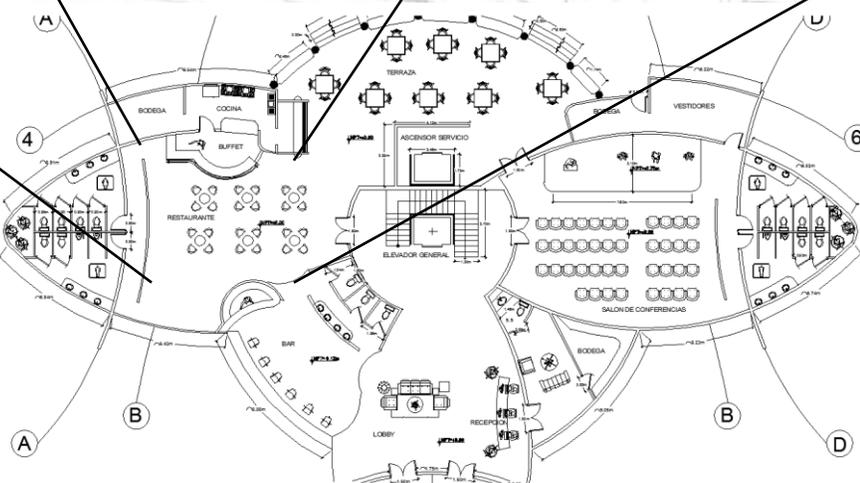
Planta arquitectónica primer nivel, área de restaurante
